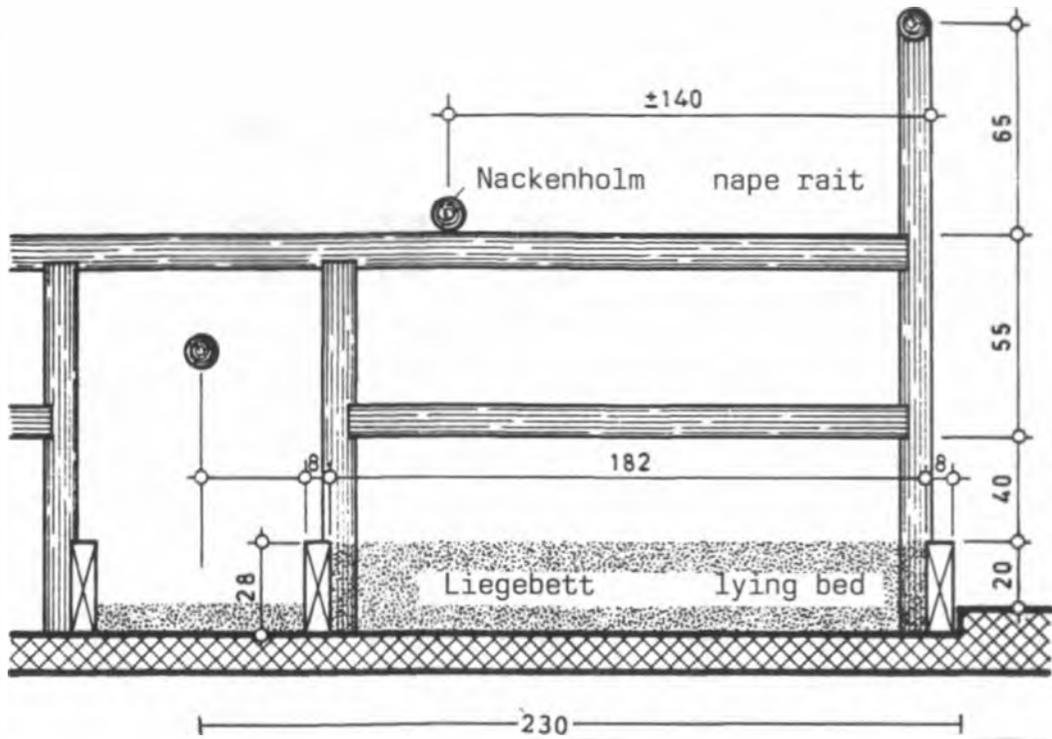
Gegenständige Boxe mit Abschrankungen aus Rundholz (Durchmesser 10 - 15 cm)
